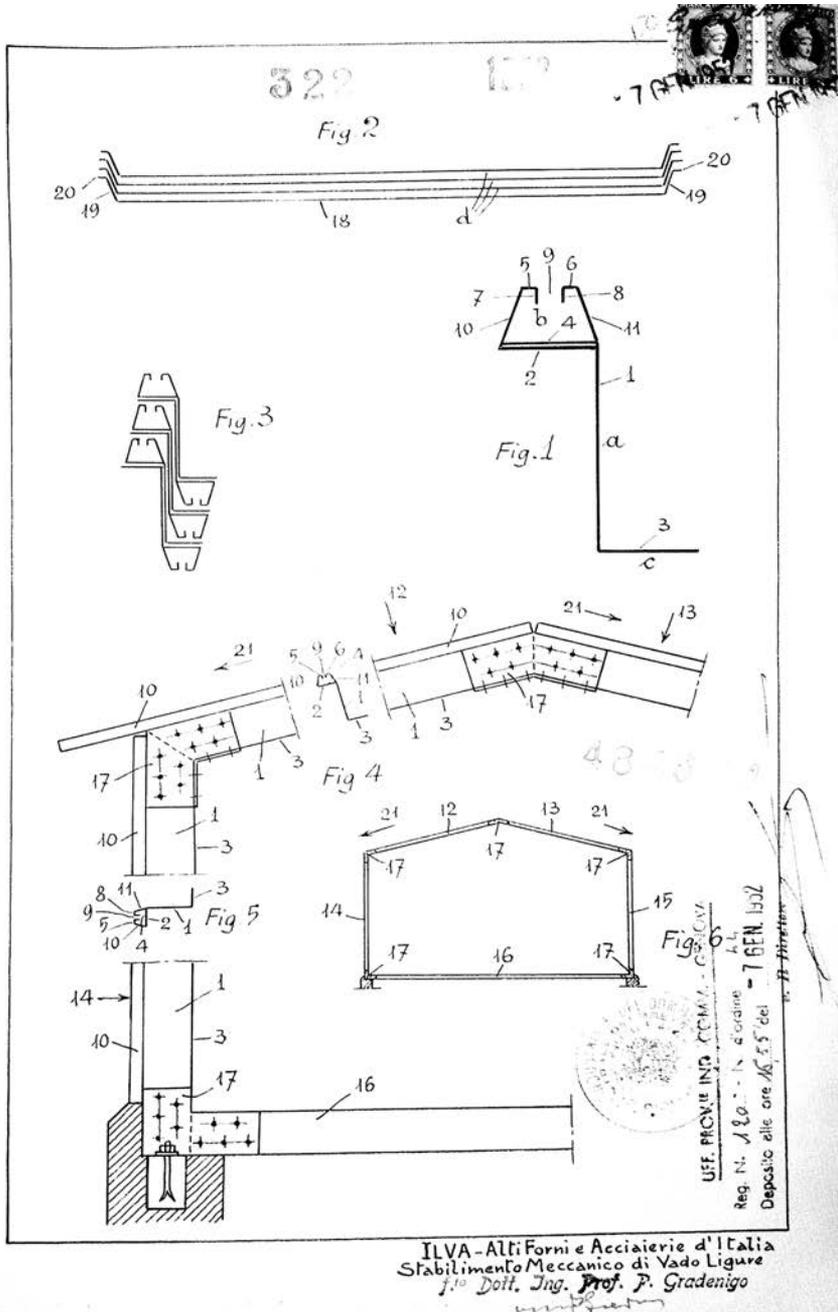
ILVA, brevetto n. 484674, “Padiglione smontabile in elementi metallici e lamine o lamiere nonché elementi metallici a sezione particolare”, depositato il 7 gennaio 1952 (ACS, UIBM).
